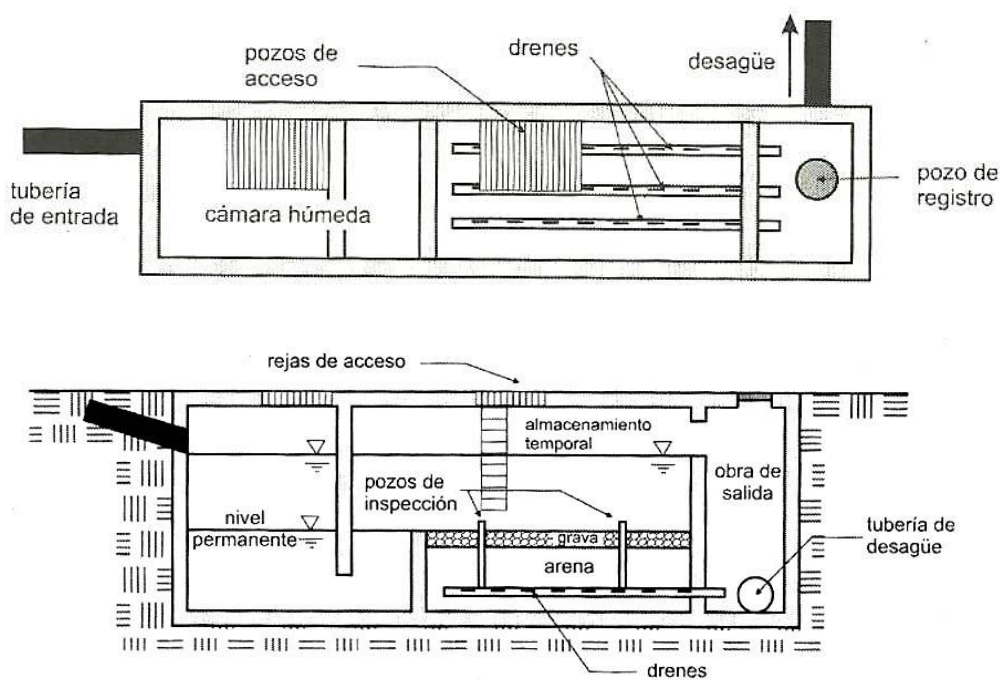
Esquema de la planta y el perfil de un filtro enterrado. Fuente CEDEX (2008).
